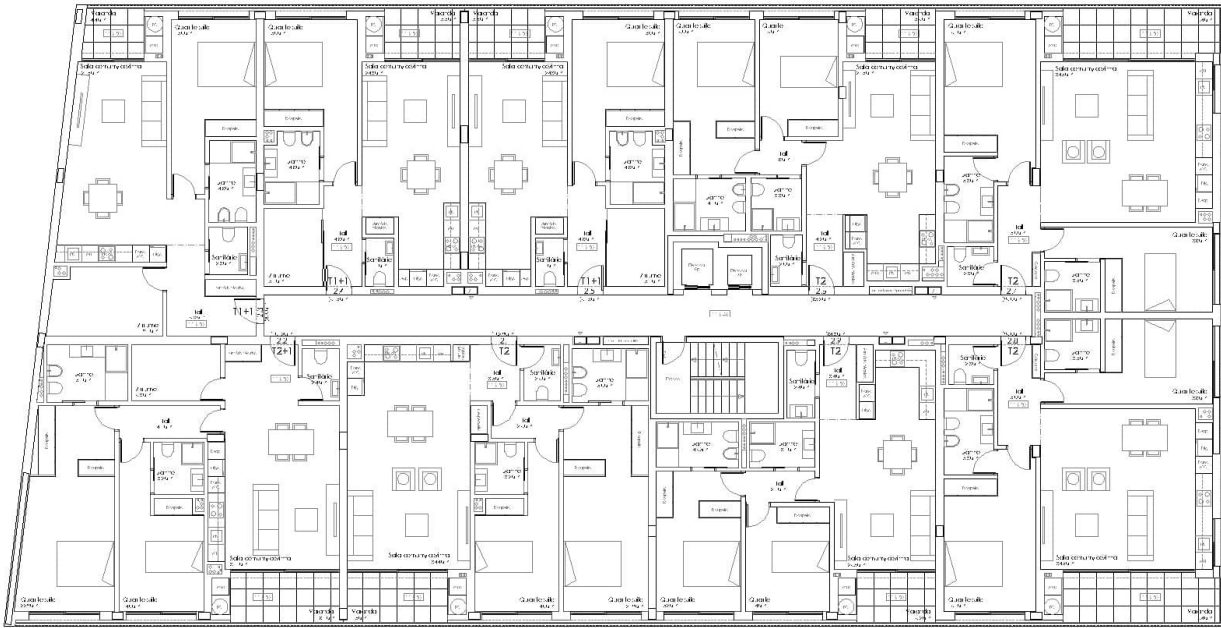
Planta arquitetônica dos pisos 1 a 3 (Projeto de Arquitetura)
